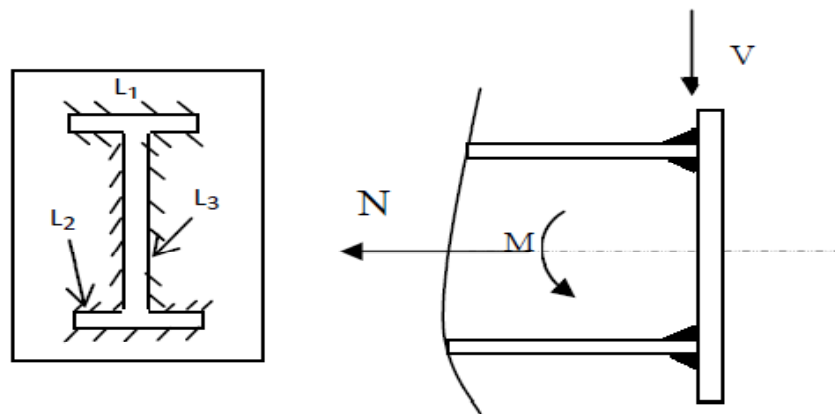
cordons de soudure : L_1 et L_2 attachent la platine avec les semelles de la poutre. L_3 assure l'attache platine-âme de la poutre.
